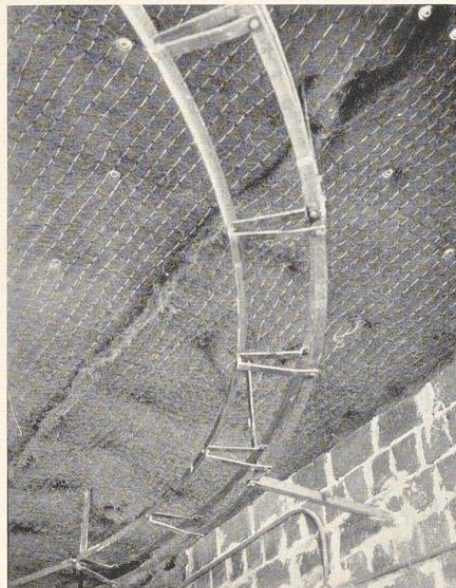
Teilbild der Formeisenkonstruktion von Bild 980 mit der hier gut sichtbaren Befestigung an Wand und Decke
